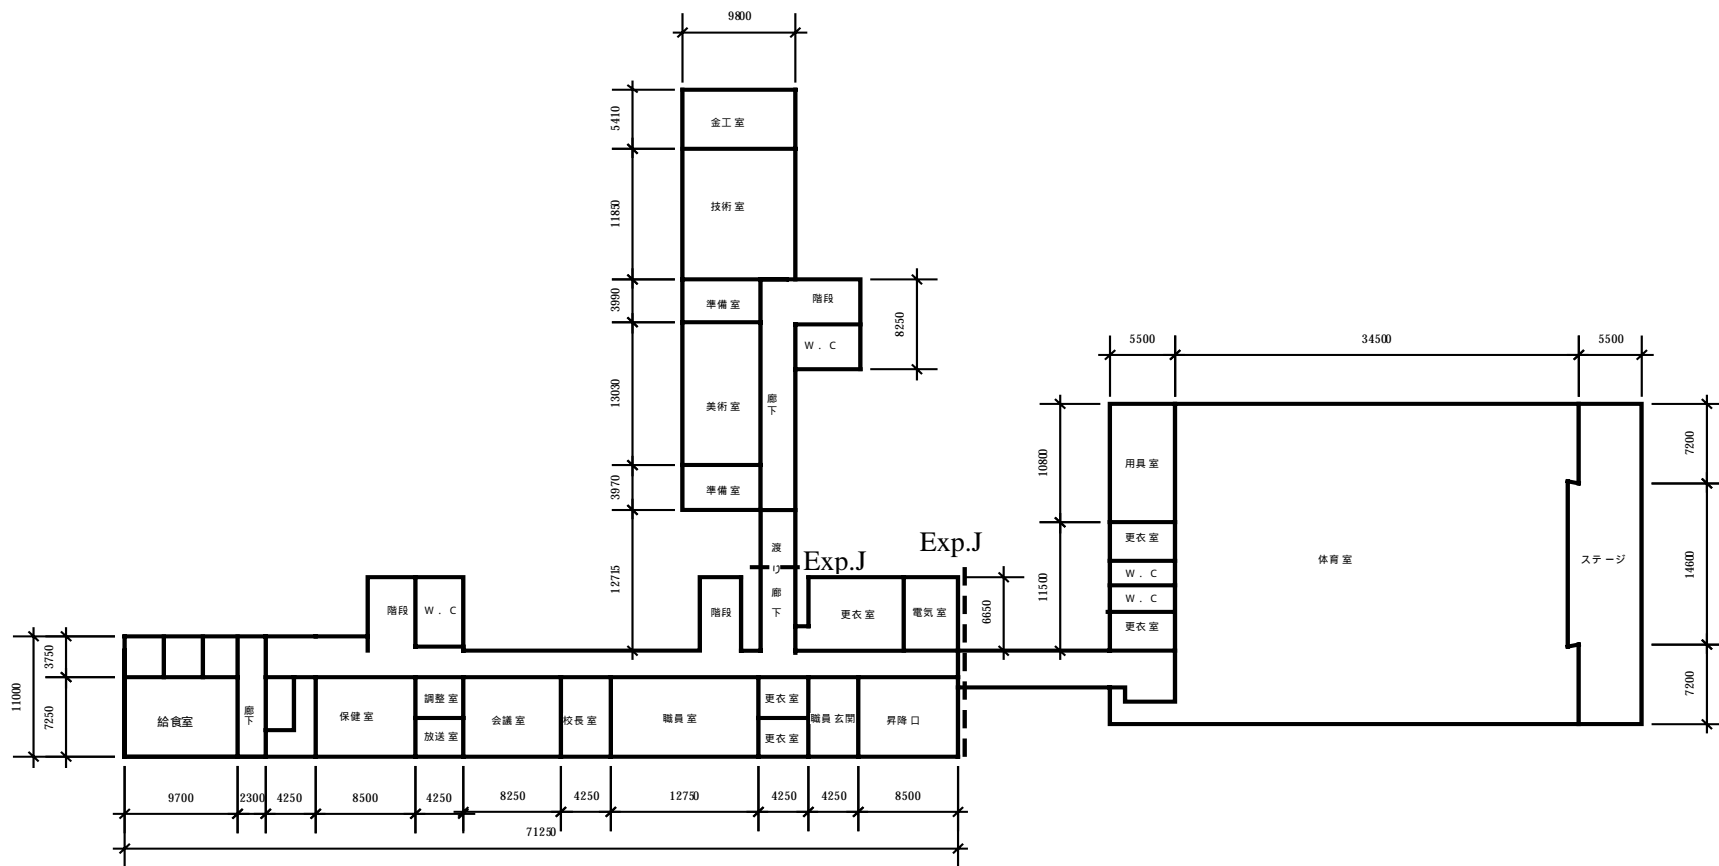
普通教室棟/特別教室棟/屋内運動場 1 階平面図
